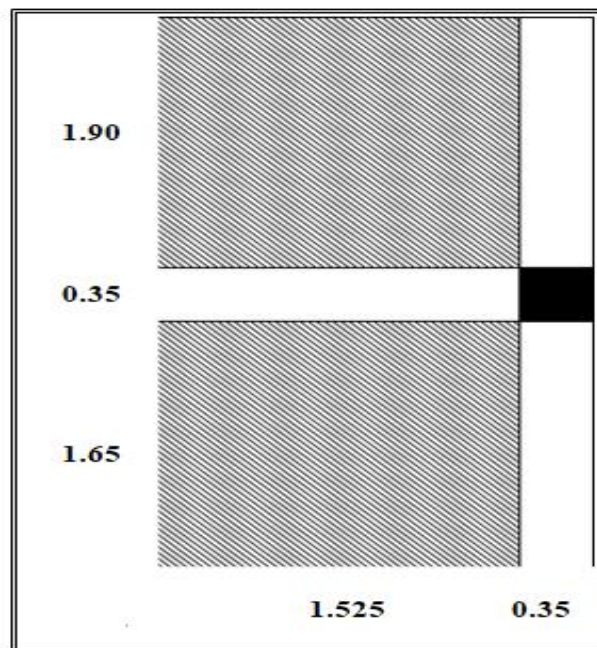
Croquis d'un poteau de rive (C-2)
